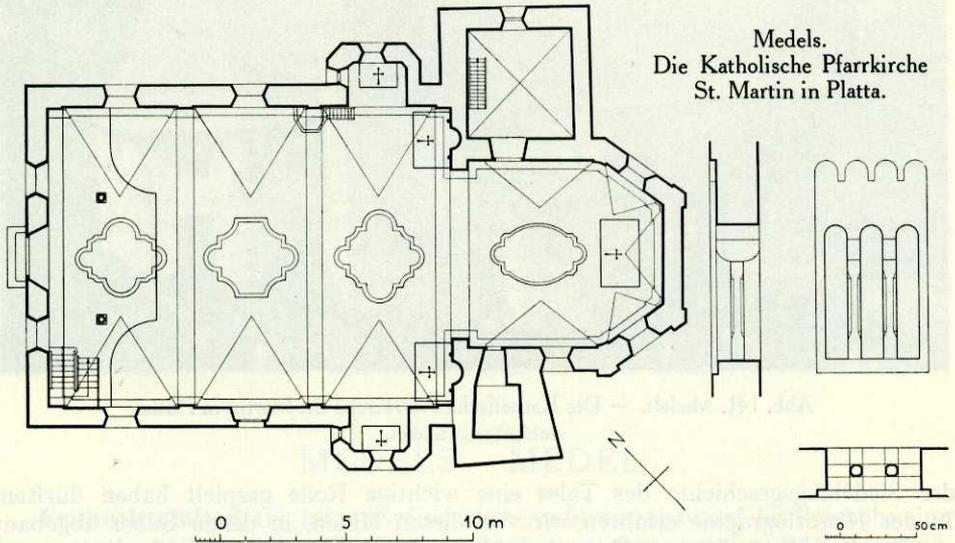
Grundriss. — Maßstab 1:300.
